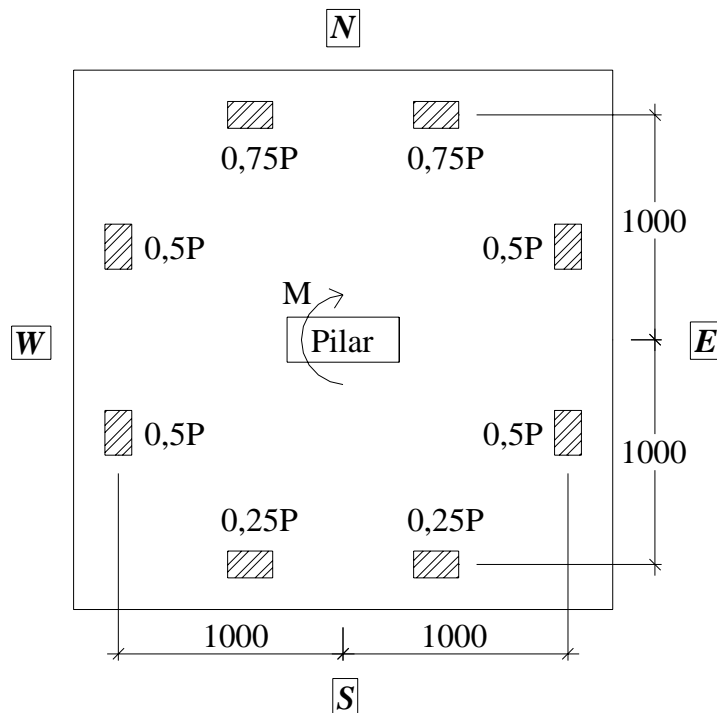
Carregamento das lajes L15, L17 e L18 (dimensões em mm)
